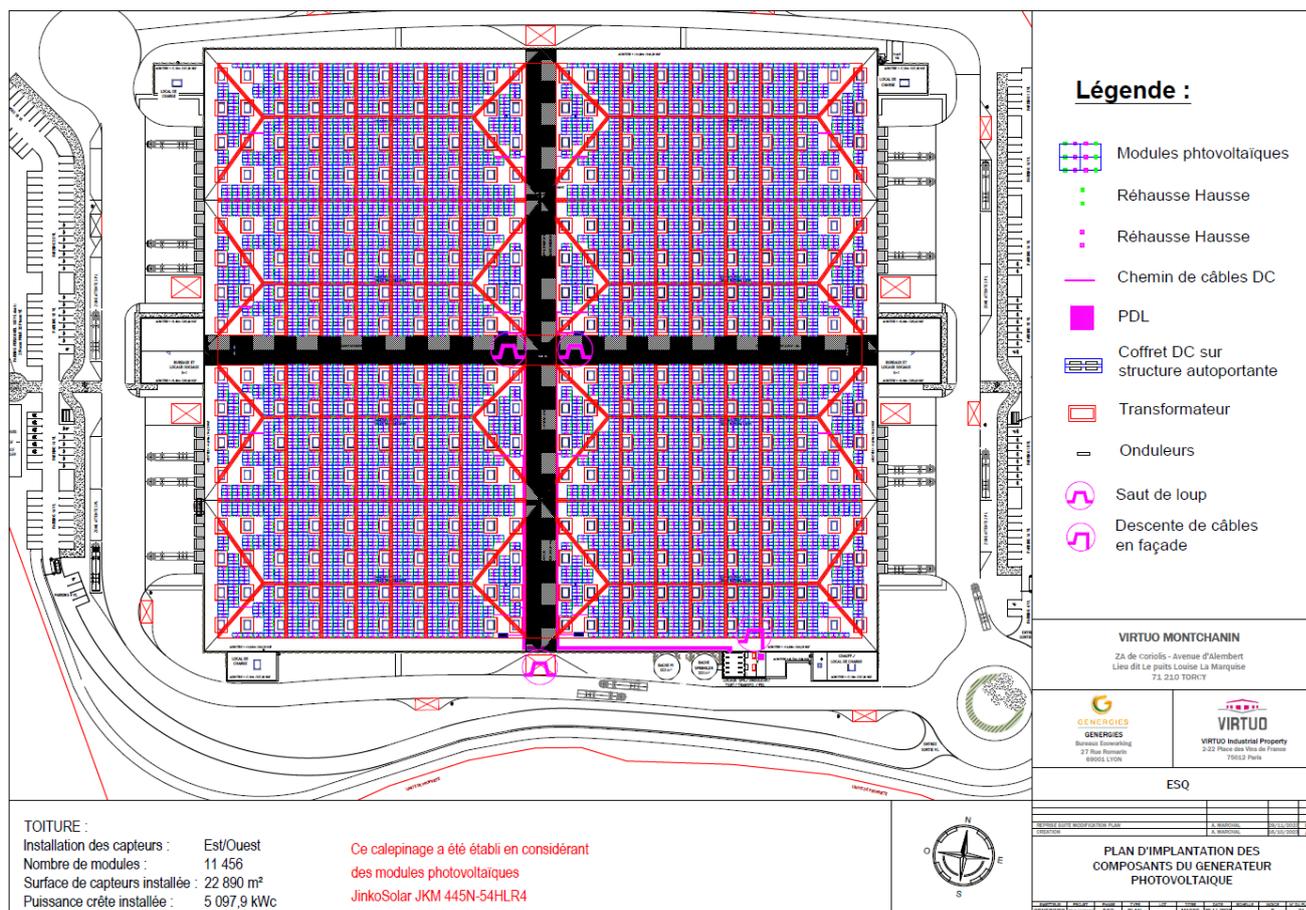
Plan d'implantation des panneaux photovoltaïques de l'entrepôt
